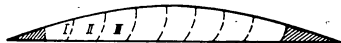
Schemat wykonywania wykopu koparką z przedsiębierną łyżką.
